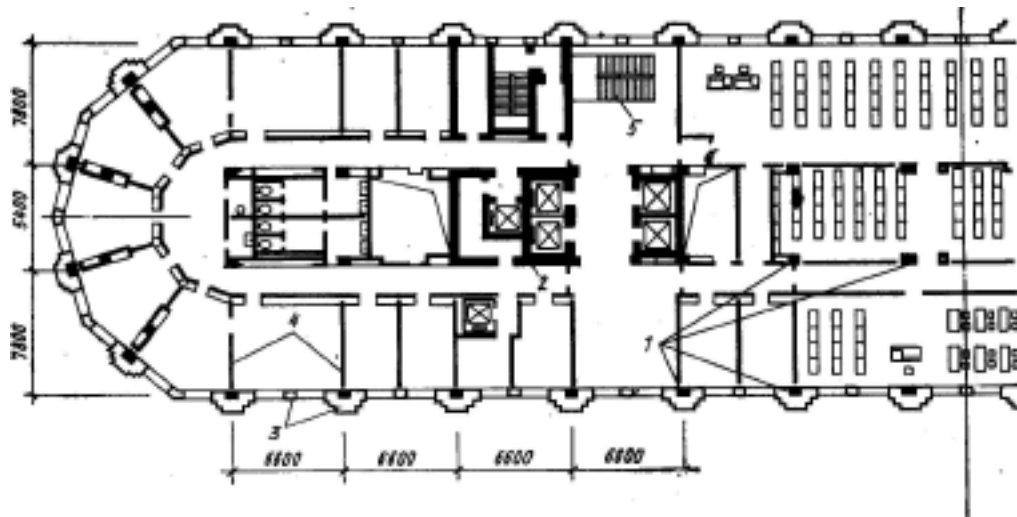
Административное здание на Краснопресненской набережной:
